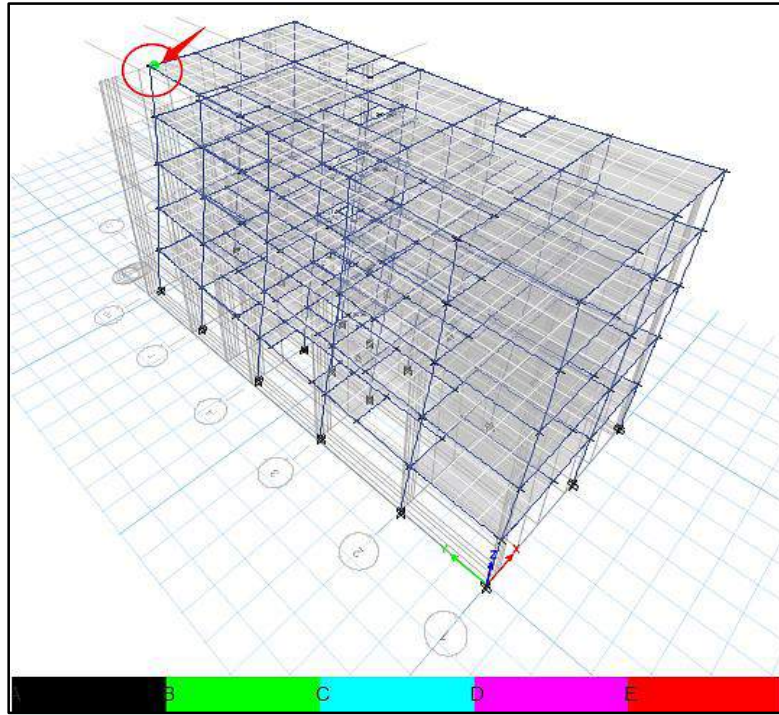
Primer Paso de generación de rotulas plásticas en el modelamiento de la estructura.
